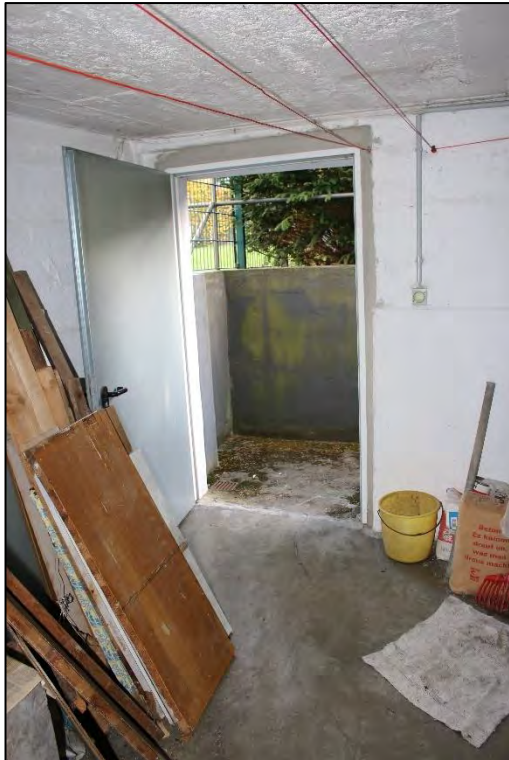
Kellergeschoss, Kelleraußeneingang
